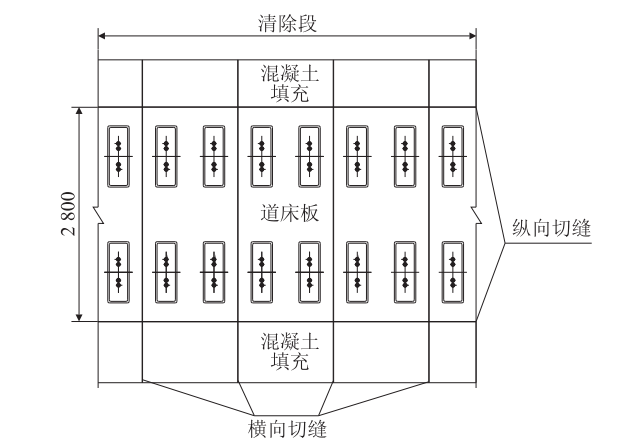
道床板及两侧混凝土填充切割示意图 (mm)
